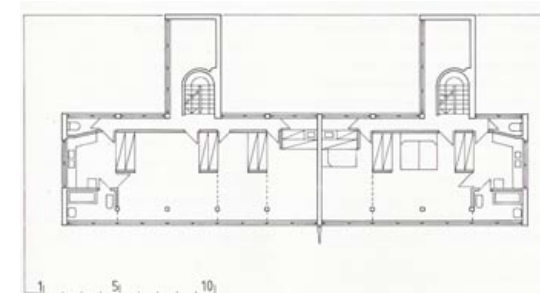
Grundriss 1.OG, Doppelwohnhaus.
